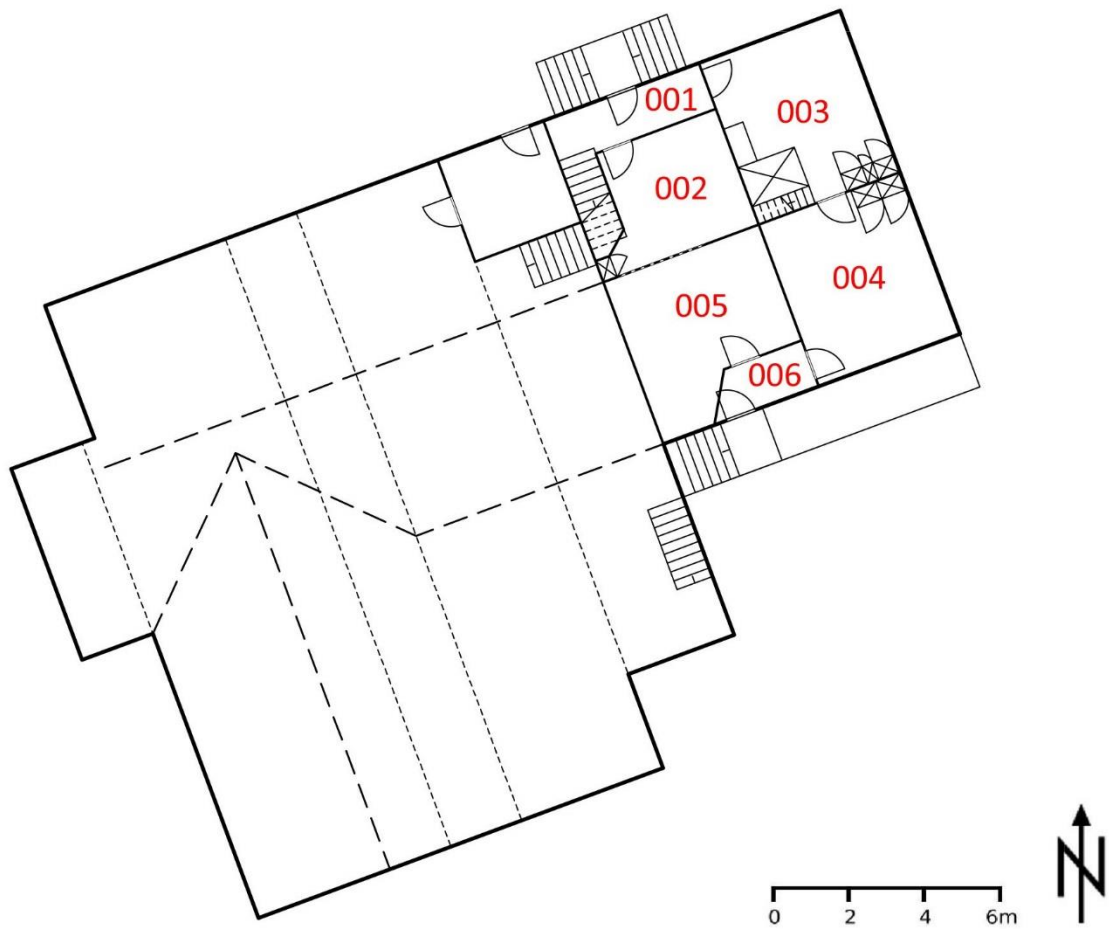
Schematischer Grundriss des Hochparterres.
